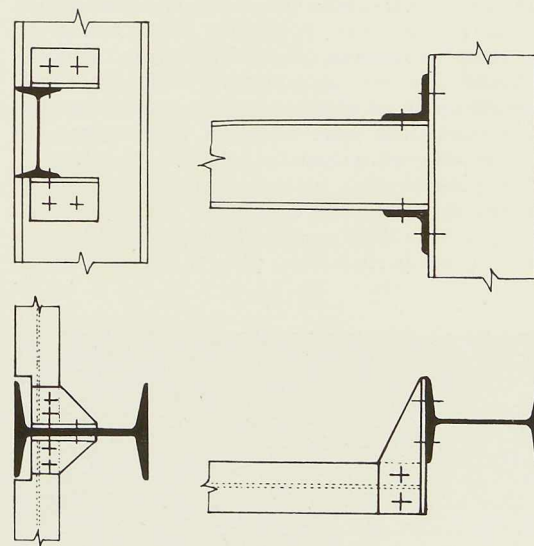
Quelques assemblages des poutres porte-murs avec les colonnes. Ces assemblages, dont on remarque la simplicité, sont raidis par l'enrobage en béton.
